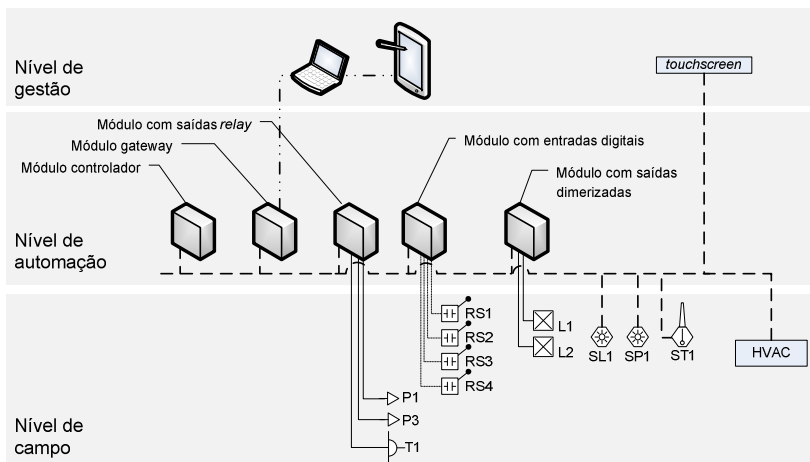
Exemplo parcial de *wiring plan* (planta física).
